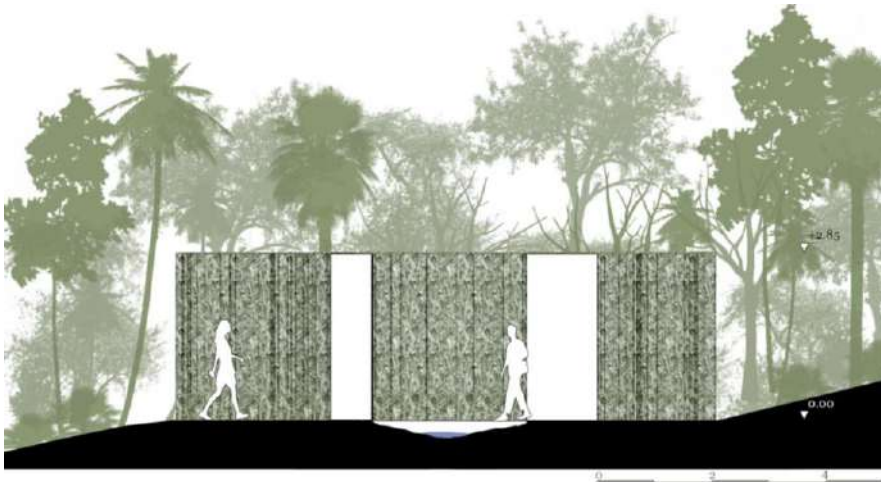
| “Vegetation Room”, Corte Longitudinal (Elaborado pela autora, 2024).
